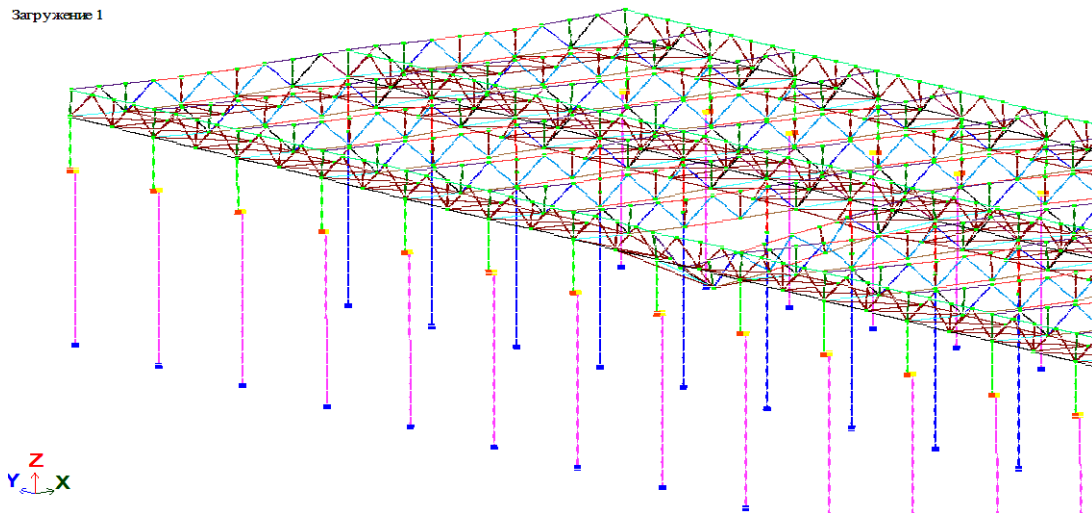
Перемещение покрытия при удалении опорного раскоса (связи между колоннами и подкрановые балки условно не показаны)
